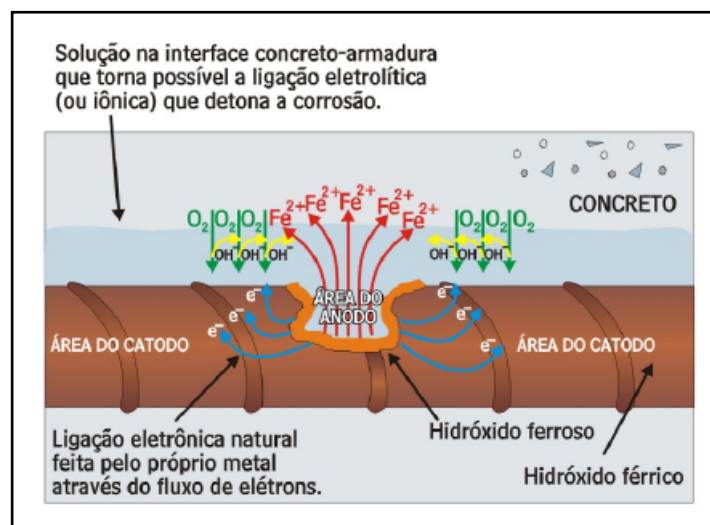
Pilha eletroquímica de corrosão no concreto armado.
